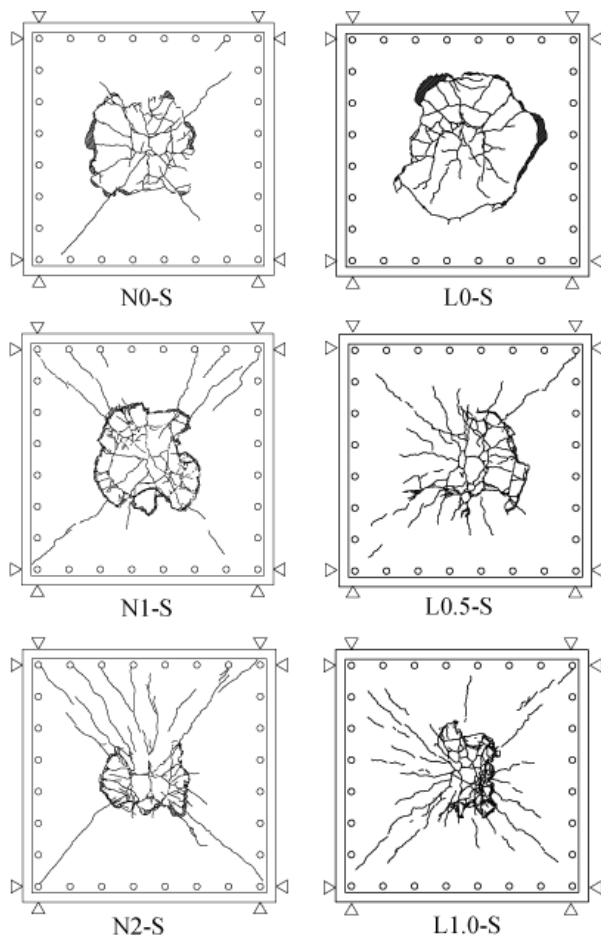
静載荷実験後の各試験体下面のひび割れ状況
